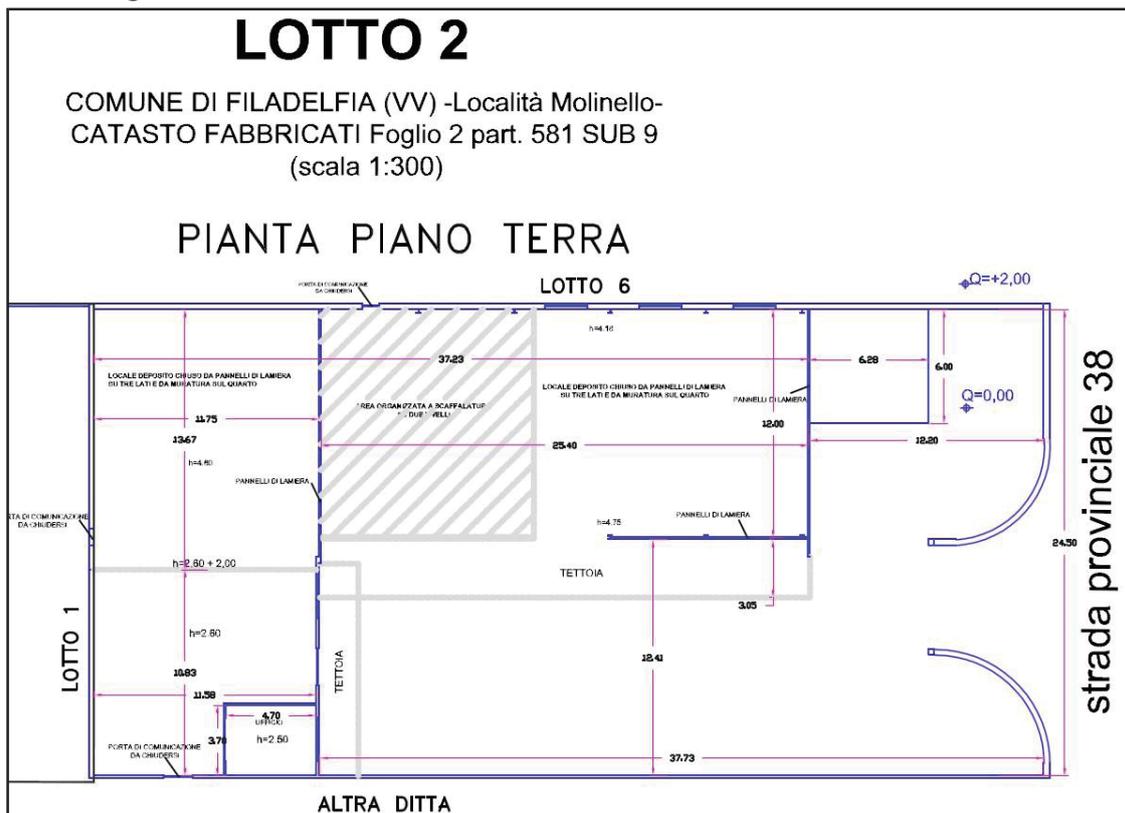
stralcio planimetria lotto 2 Allegato 10
